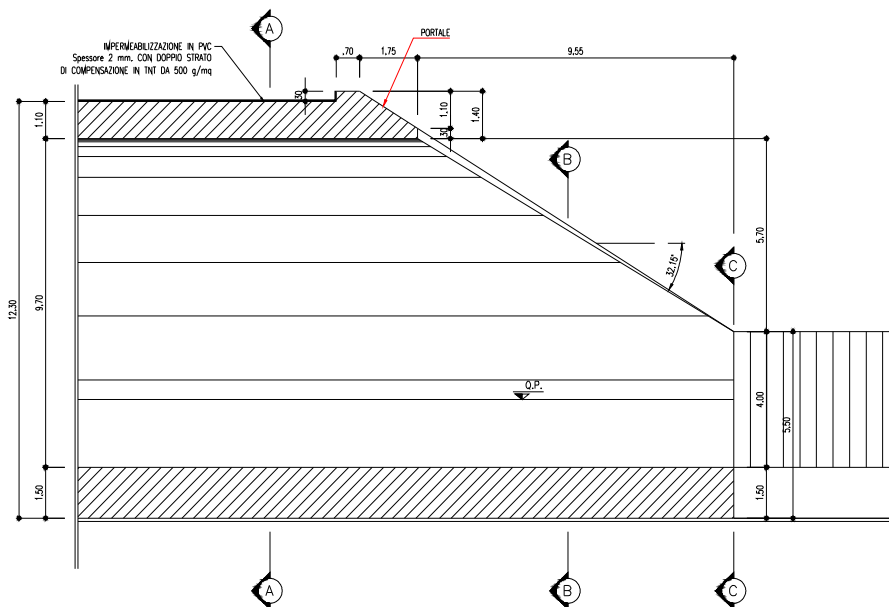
sezione tipo di imbocco PE lato caltanissetta
